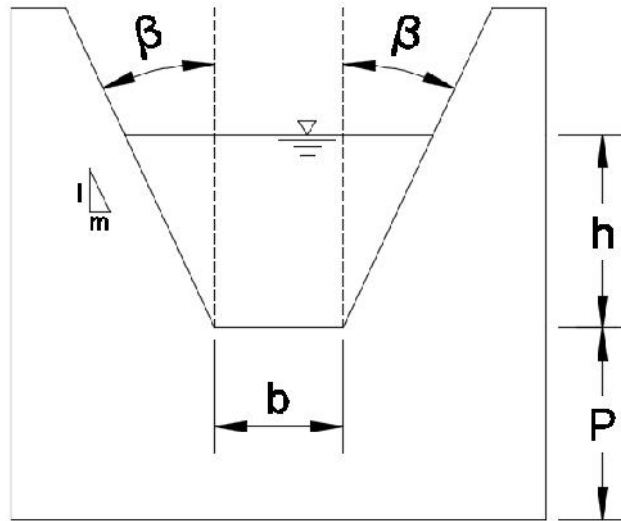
Vertedero trapezoidal - Dimensiones.
